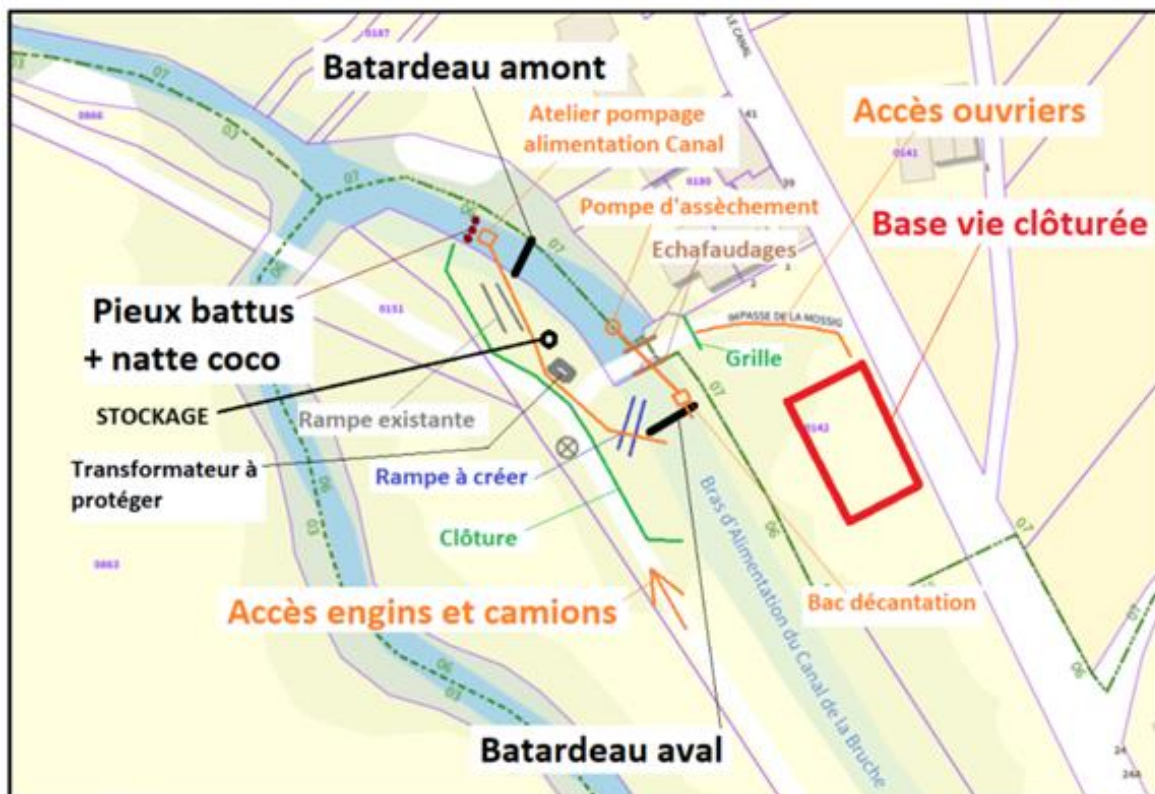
Plan du chantier sur la prise d'eau du bras d'alimentation du canal de la Bruche à Wolxheim (source : ARTELIA)
